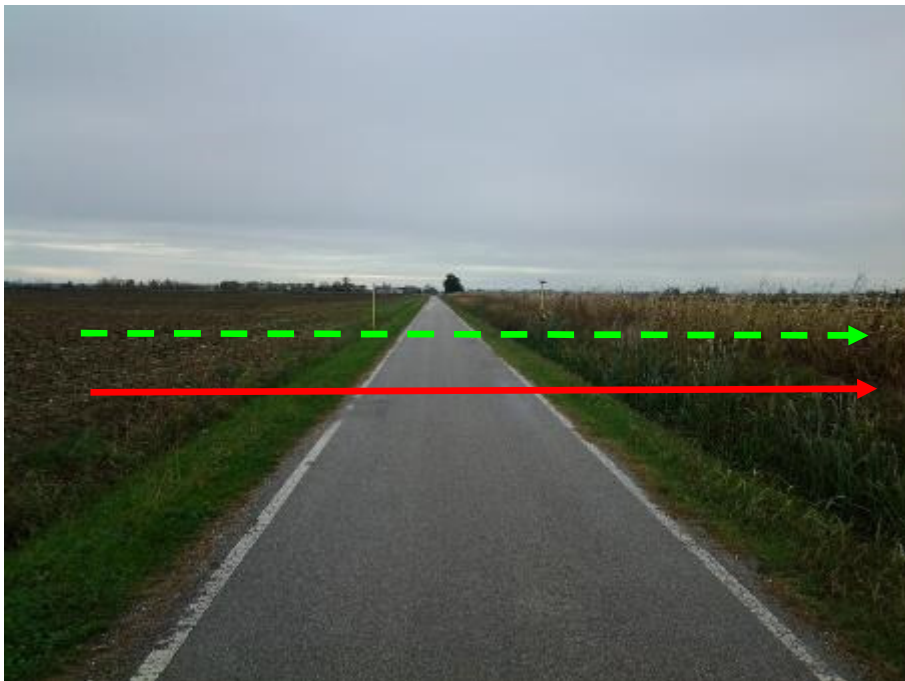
ATTRAVERSAMENTO VIA BELVEDERE CENTRO
